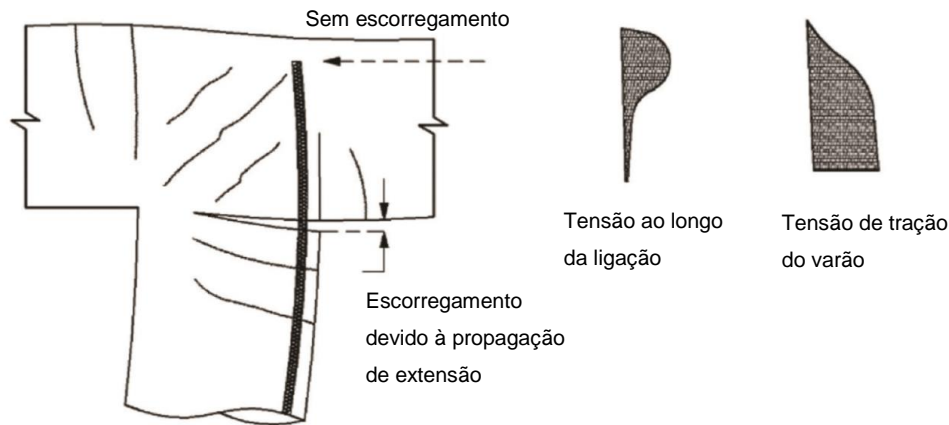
Escorregamento de armaduras por propagação de extensões na zona de amarração (Adaptado de *Bahrani et al.* [2])
